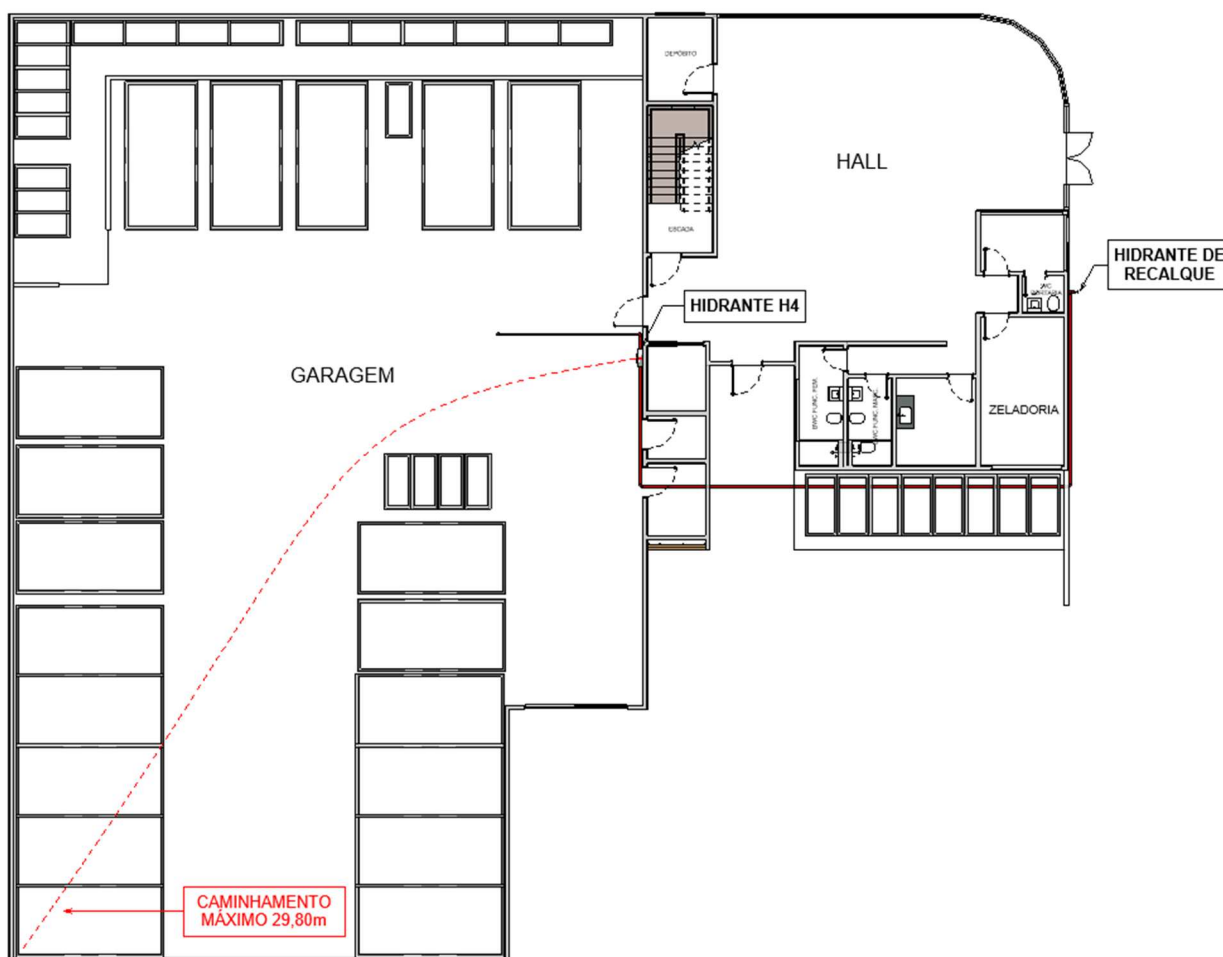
Caminhamento máximo do hidrante no pavimento tipo
